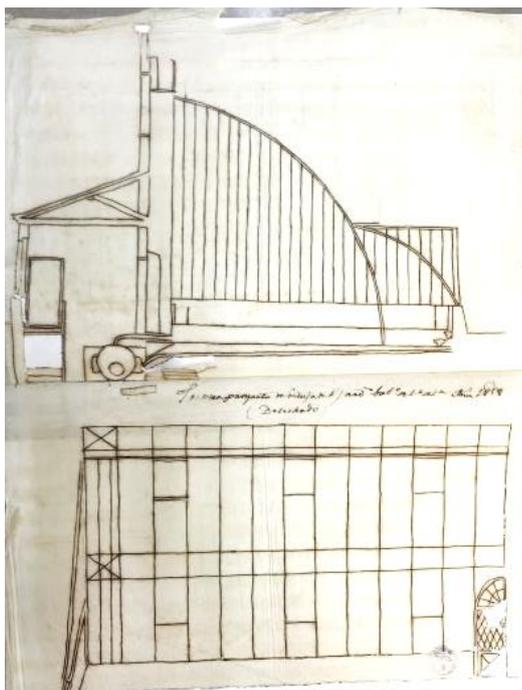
Primer proyecto para la Estufa Tropical, alzado y sección. S. MONLEÓN, 1858
